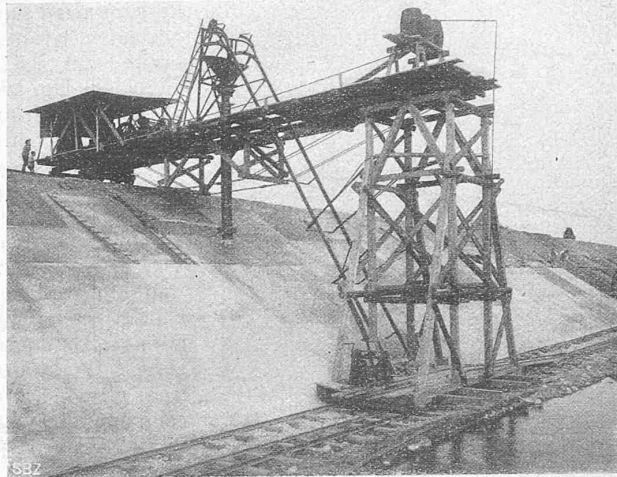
Betonauzug für die Betonierung der Böschungen.
